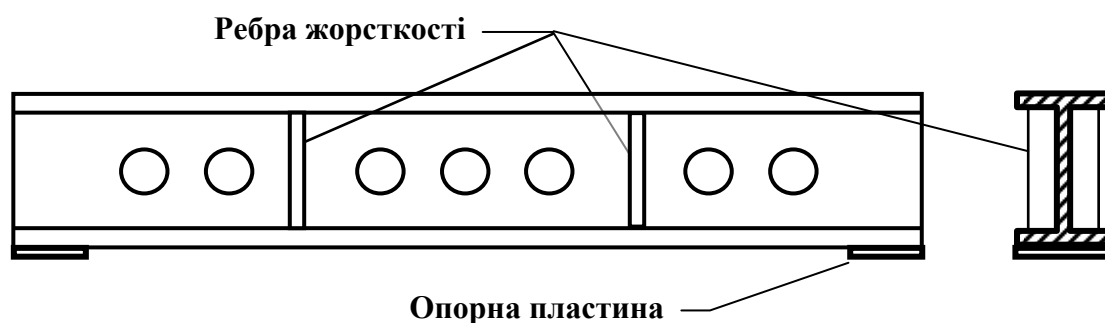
Будова сталеві кроеквяної балки покриття
